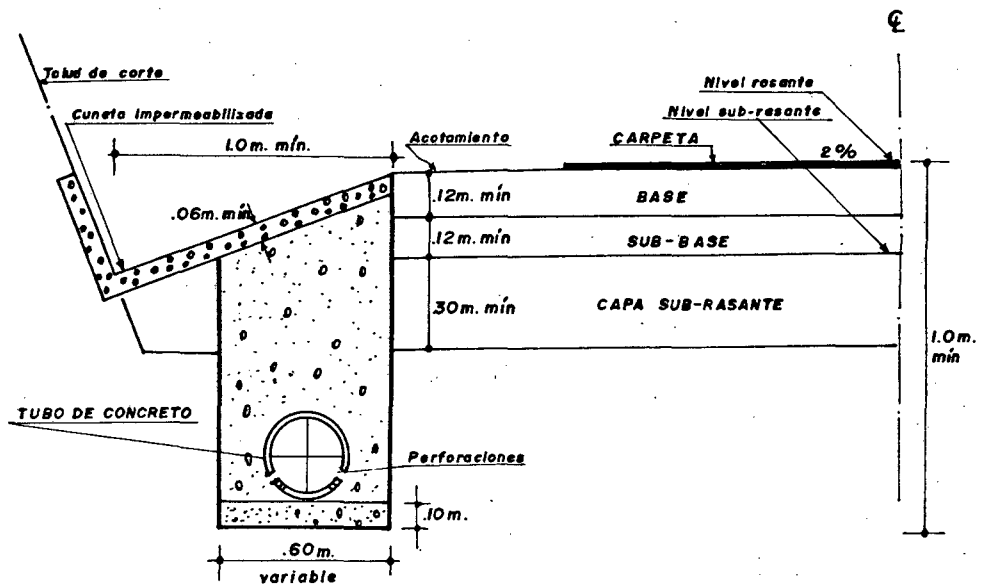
SECCION TRANSVERSAL DE UN SUBDREN LONGITUDINAL DE ZANJA
